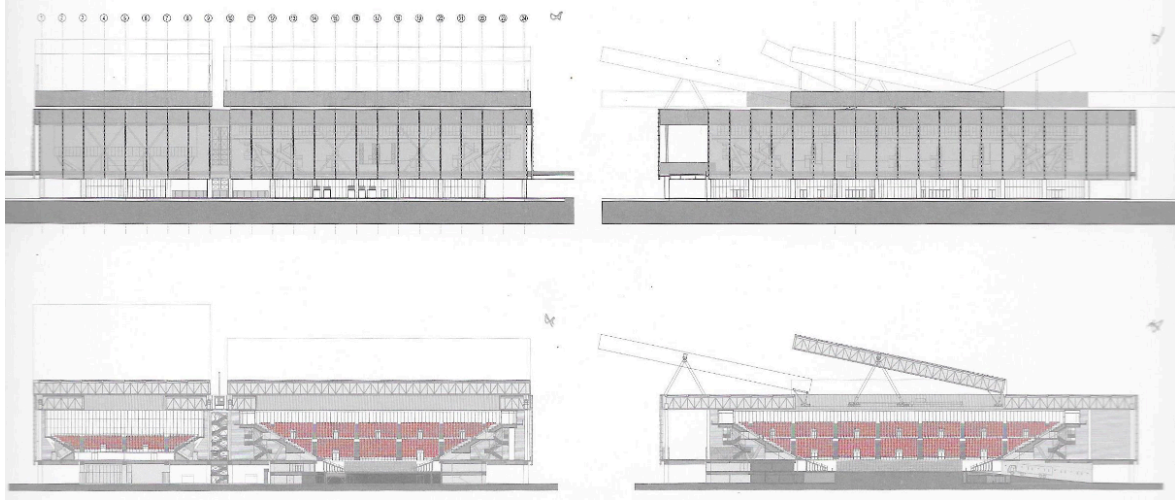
Alzados norte y oeste. Secciones de la caja mágica.
